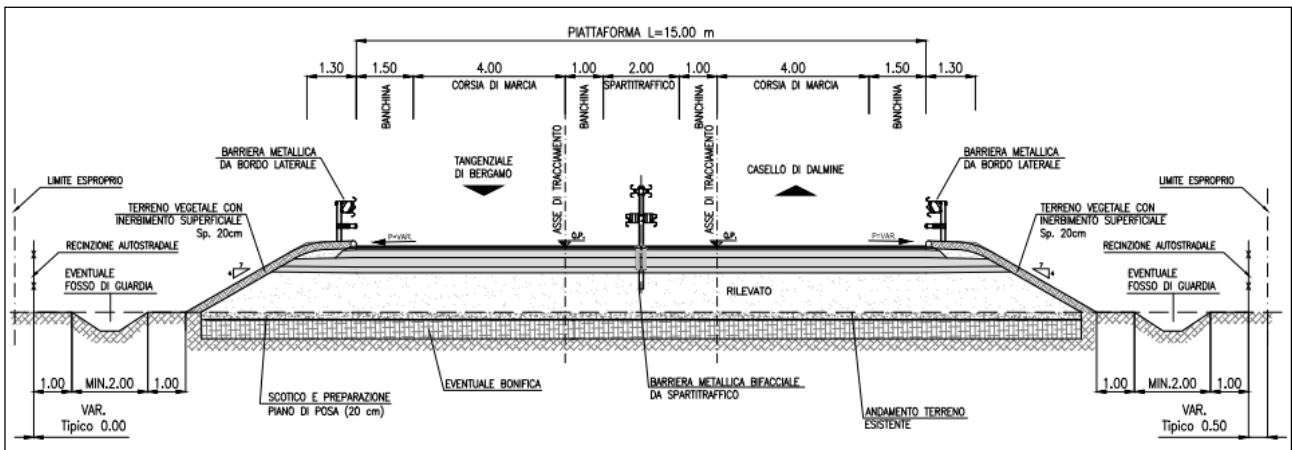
Sezione tipo rampa bidirezionale a 2 corsie
